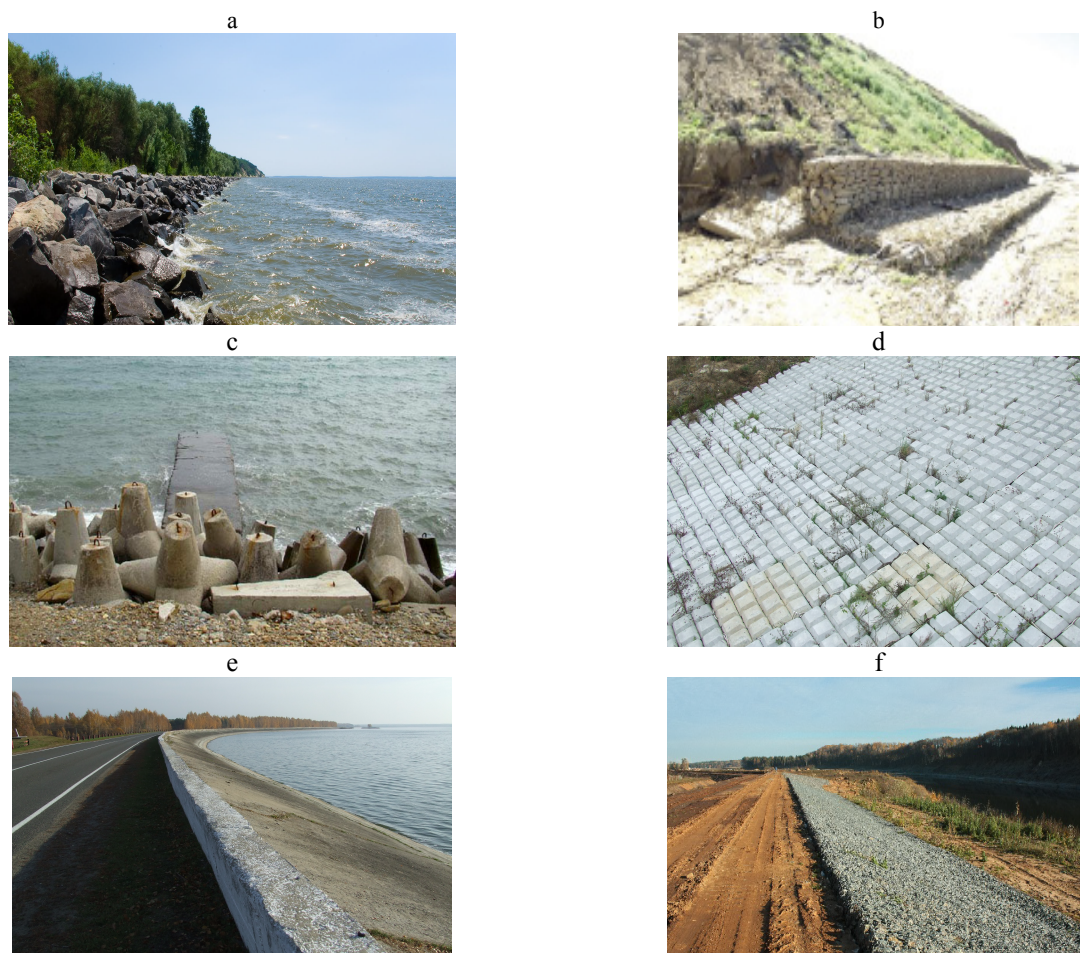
Примеры крепления откосов: а – каменная отсыпка; б – подпорная стенка; в – крепление железобетонными тетраподами; д – гибкое железобетонное крепление откоса; е – крепление откоса плитами; ф – комбинированное крепление откоса камнем и металлической сеткой
